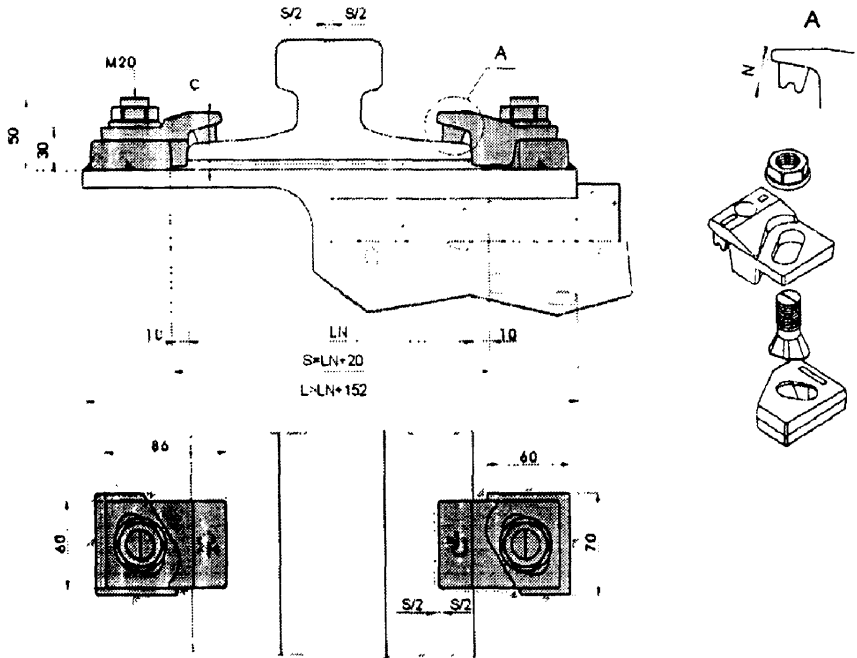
Вариант присоединения крепления рельса к подкрановой балке при помощи сварных соединений (крепление Gantrex типа 21/080)
